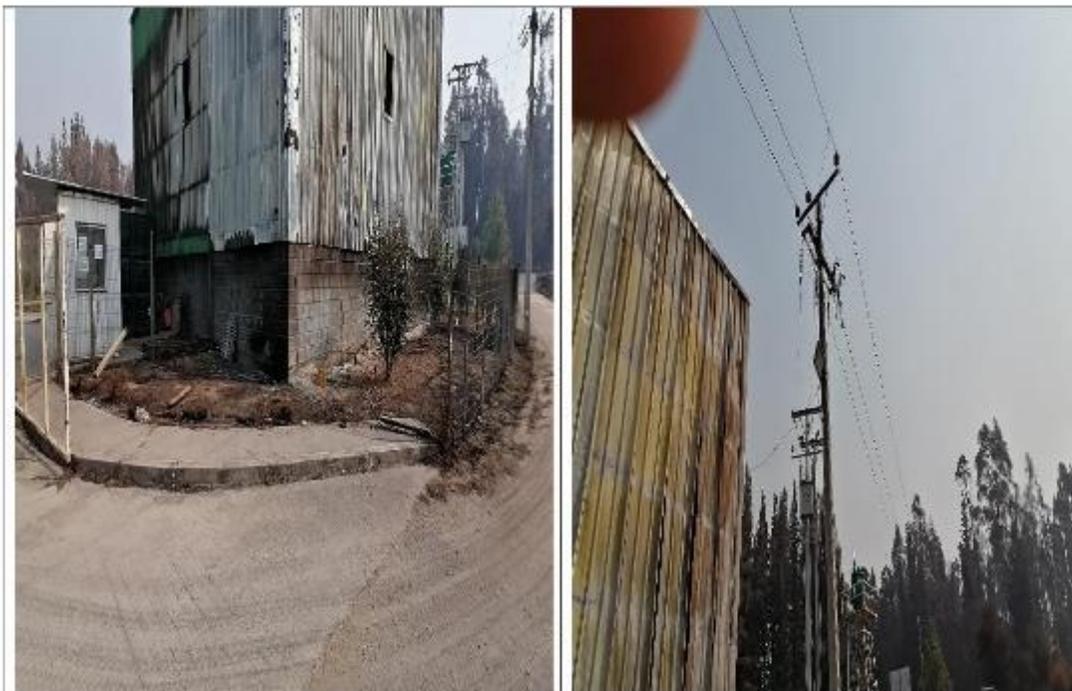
y 26: Daños por el fuego en vigas maestras del galpón de compostaje
